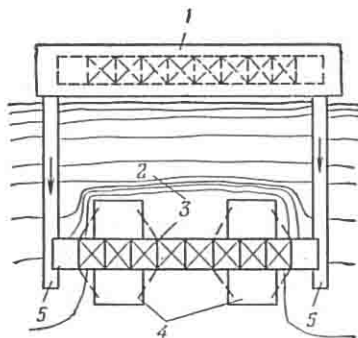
Поперечная выкатка пролетного строения на плавучие опоры:
